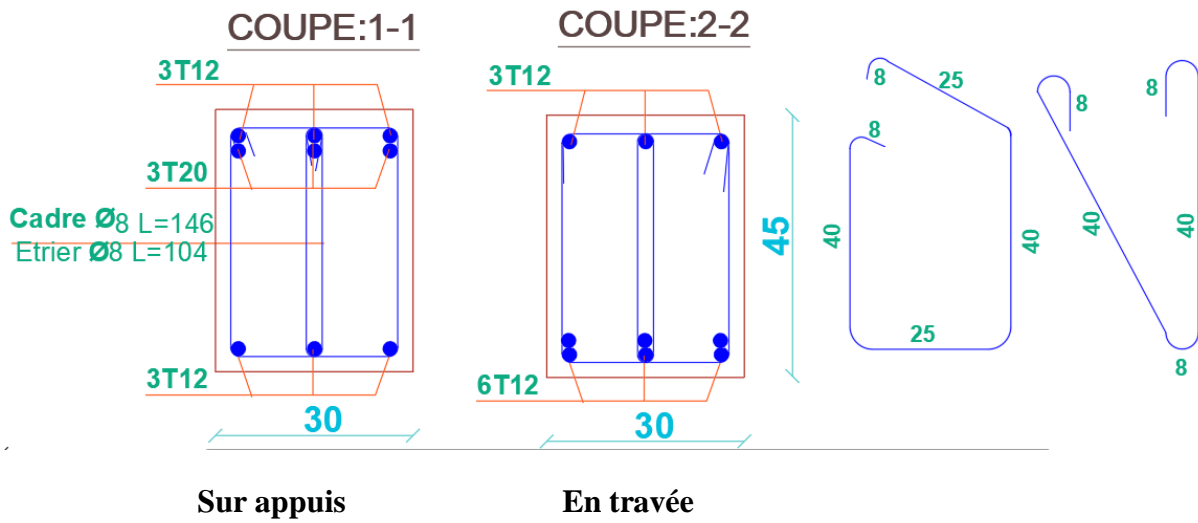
Ferrailage de la poutre principale (30× 45)
